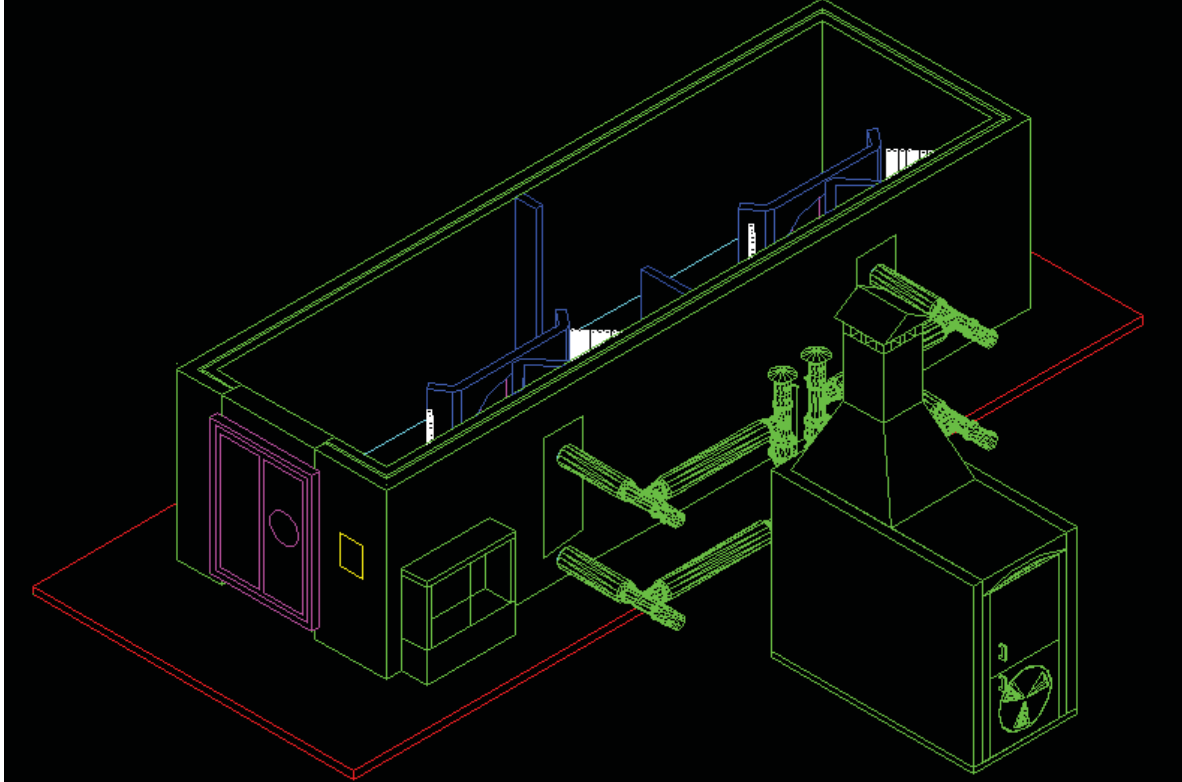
Vista isométrica de la cámara de secado y cámara de combustión.
